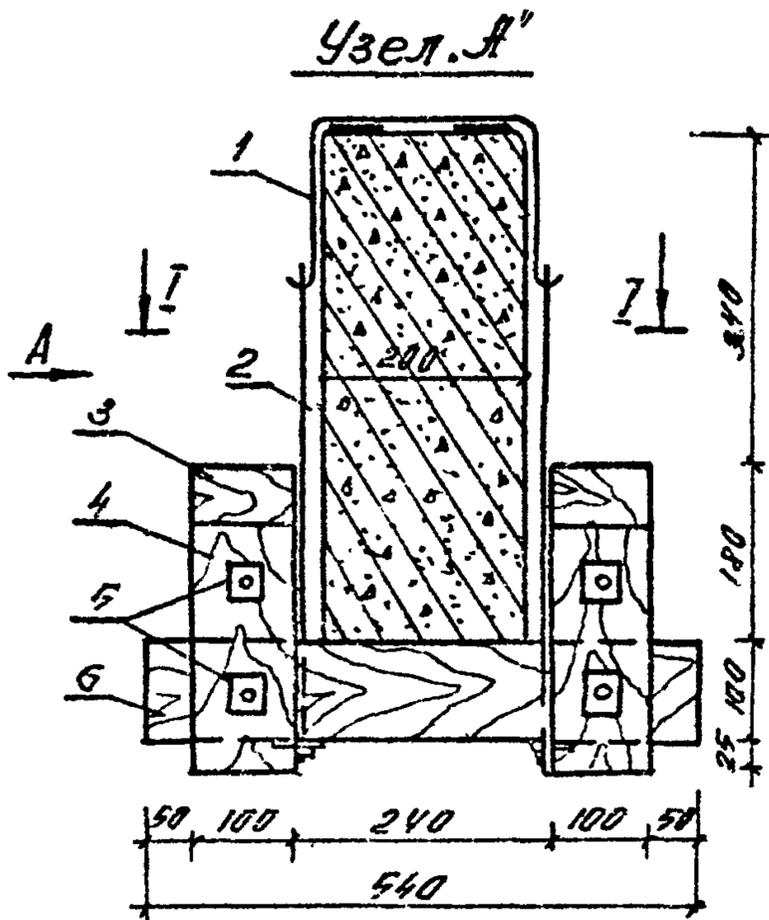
Подвесная опора и тяга. Вариант по сборным железобетонным балкам перекрытия.
